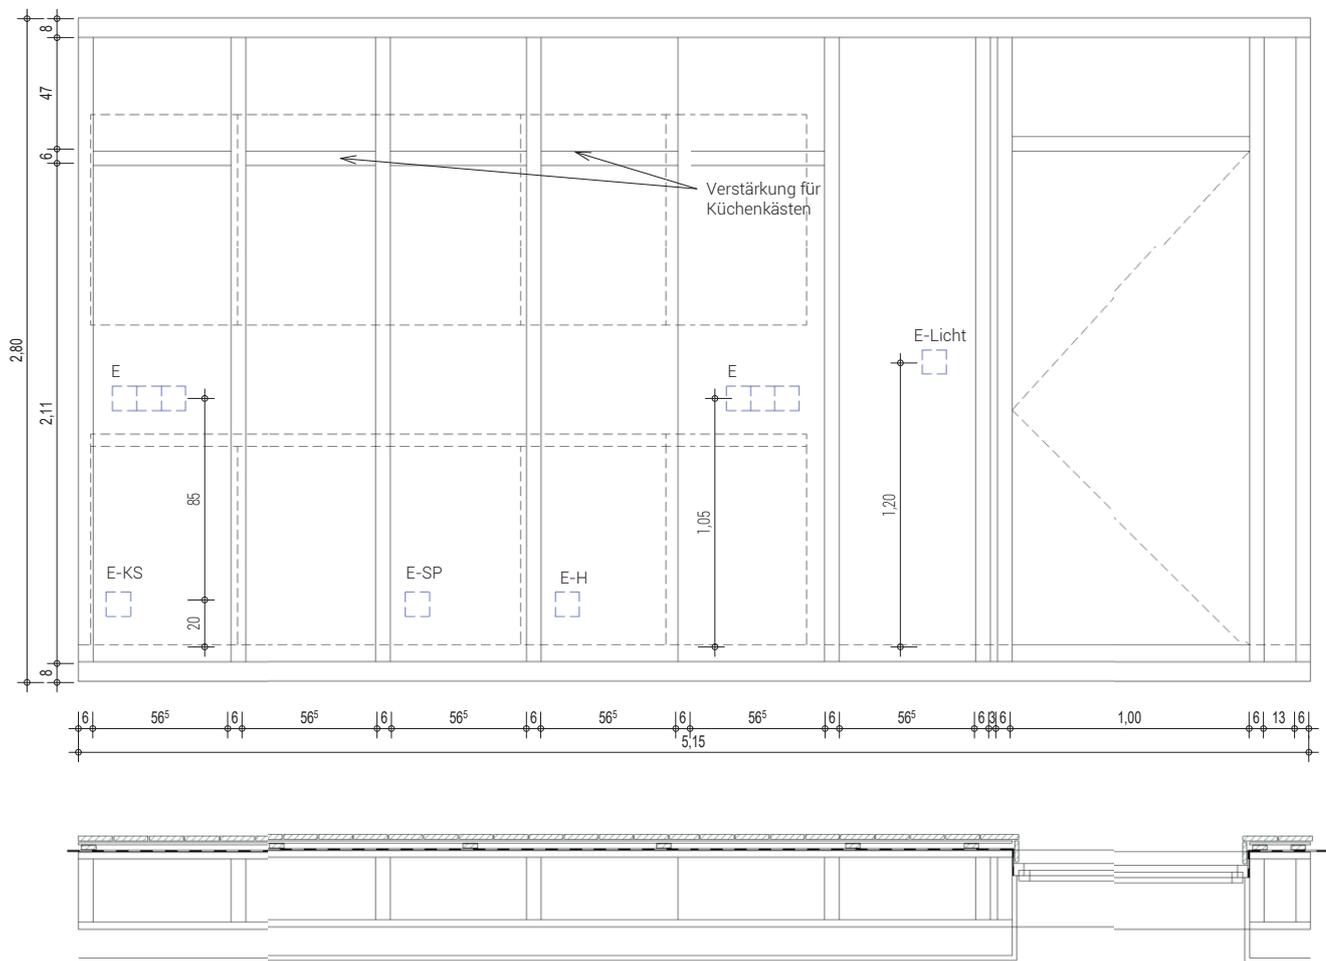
Werkplan - Grundriss und Schnitt
